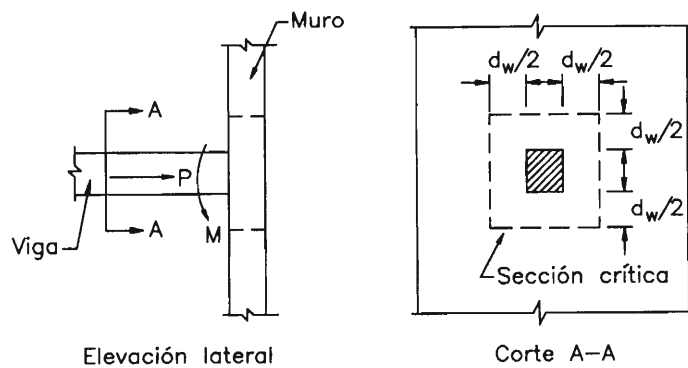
Viga conectada al muro produciéndole punzonamiento
